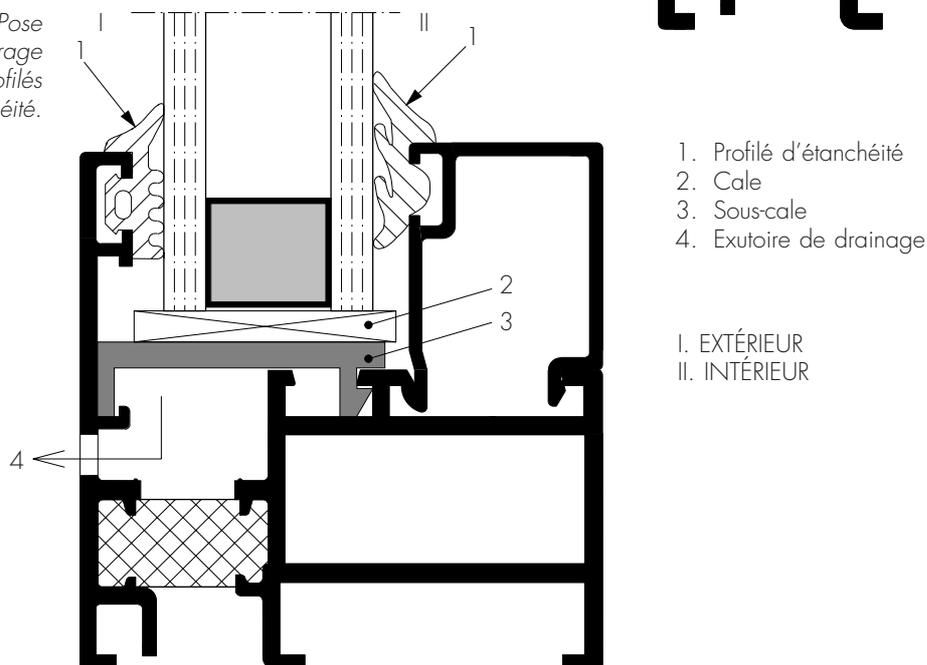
Pose d'un vitrage avec profilés d'étanchéité.
